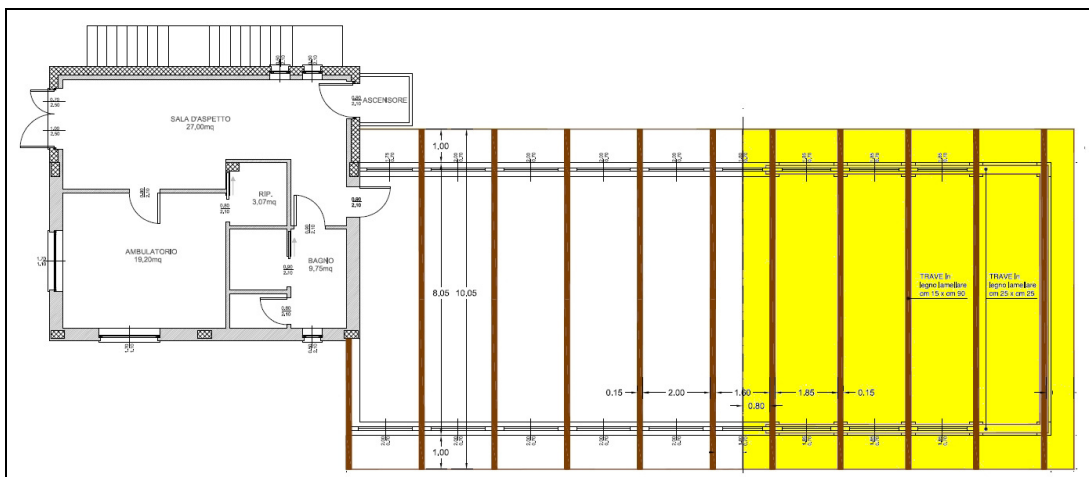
Progetto: pianta dell'orditura del tetto (tratta dalla Tavola n. 5)
